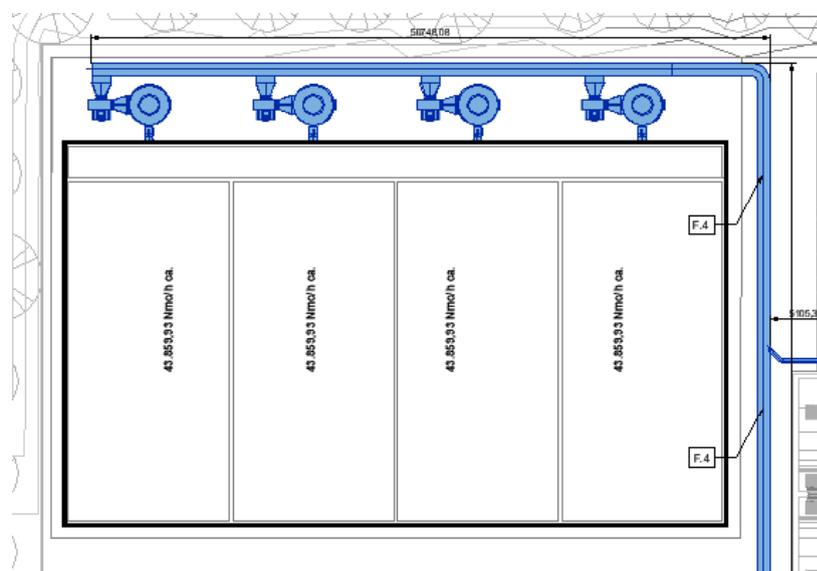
planimetria dell'area di biofiltrazione in progetto
